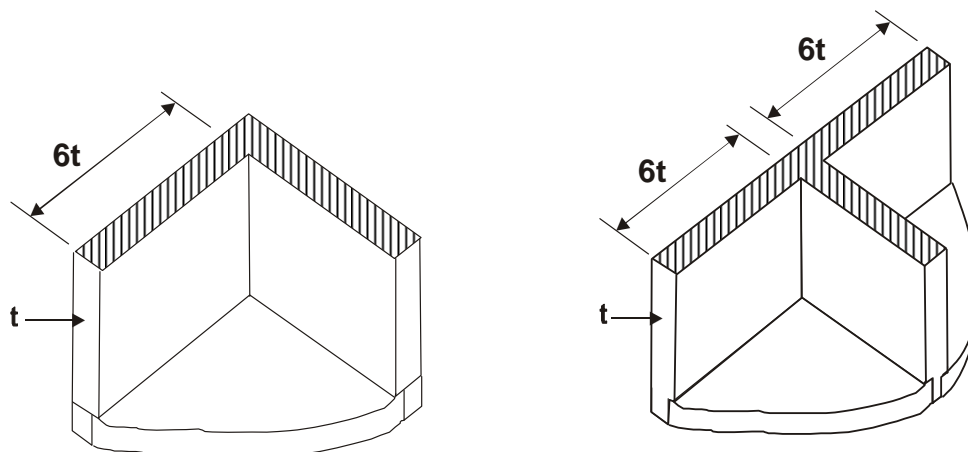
Ancho efectivo de las alas de muros de mampostería.
